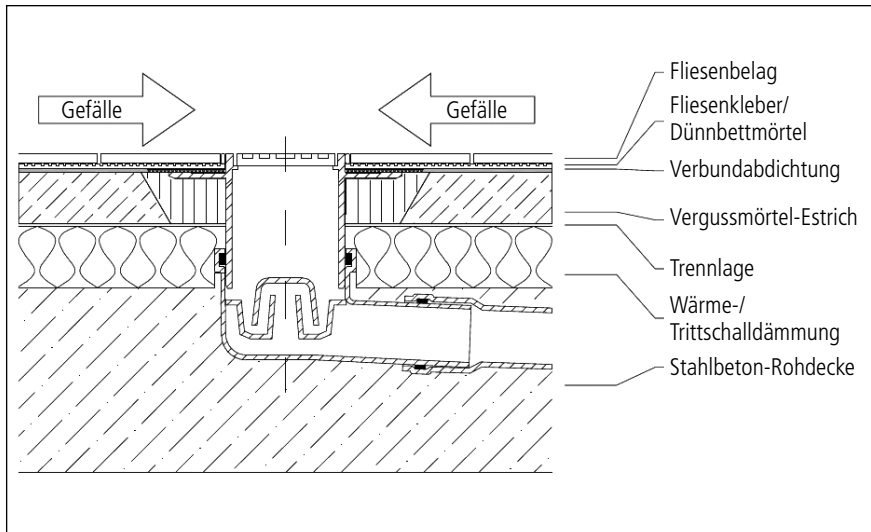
■ Anschluss eines Ablaufs an eine Verbundabdichtung mit Klebeflansch – Überblick [26]
